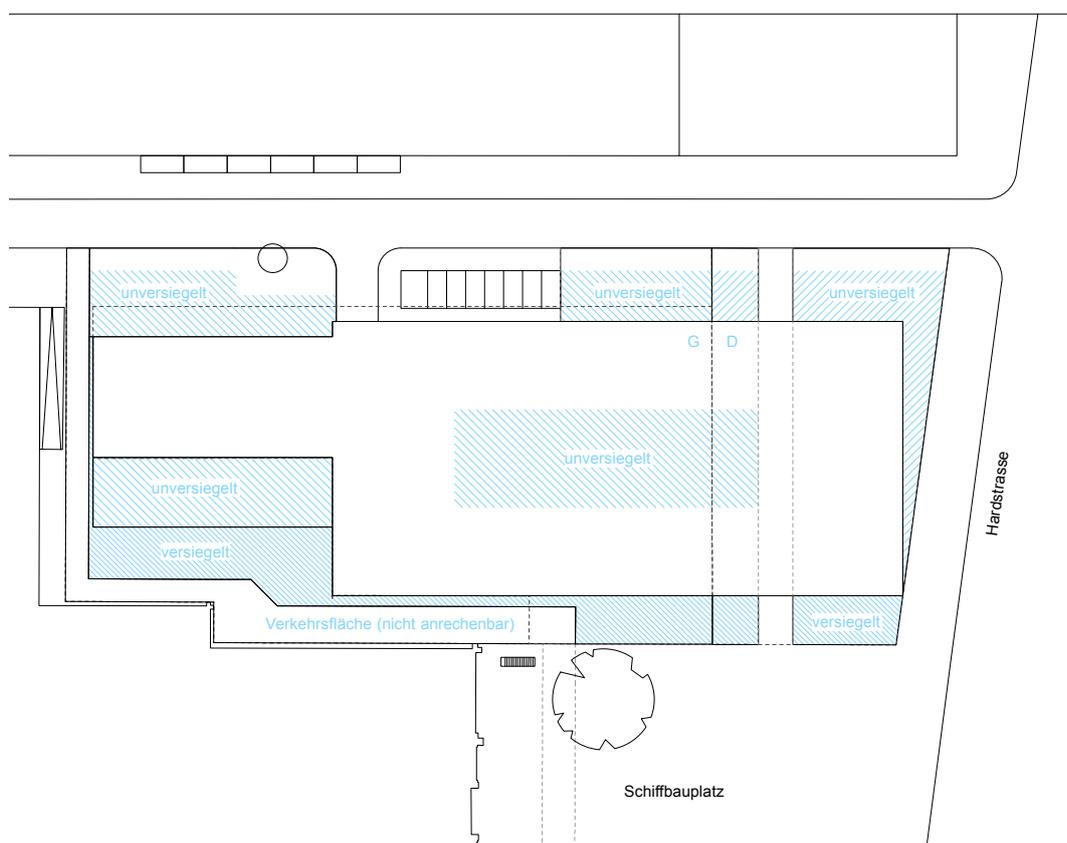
Städtebauliches Leitbild Schirmhaus, Freiflächen
